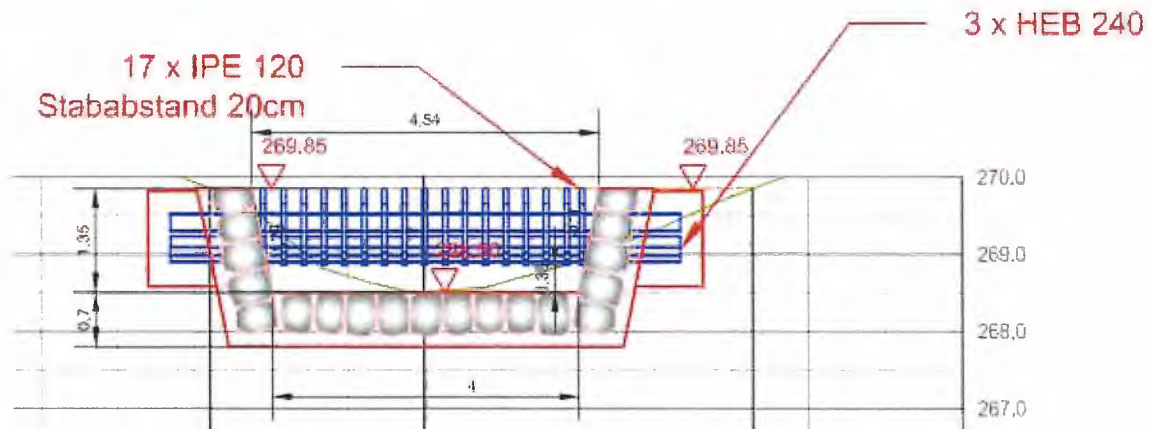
Wildholzrechen an der Stauwurzel; aus Plan 12.6
